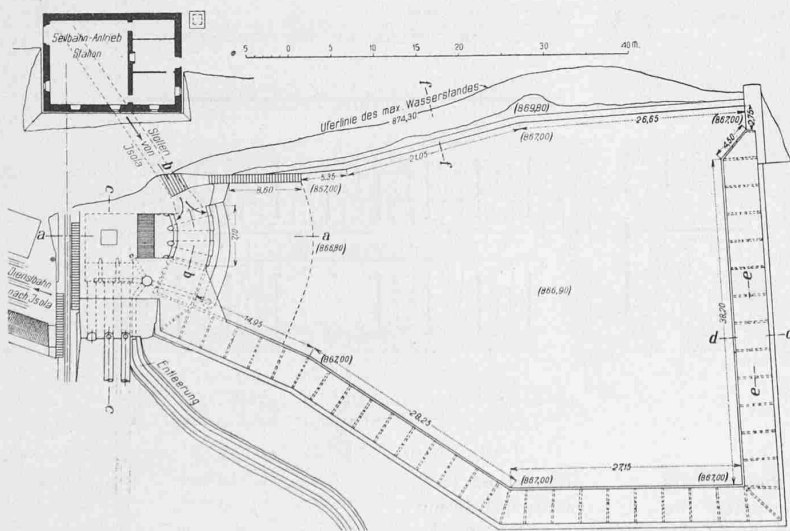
Lageplan von Wasserschloss und Ausgleichbecken Cedegolo. — 1 : 800.
